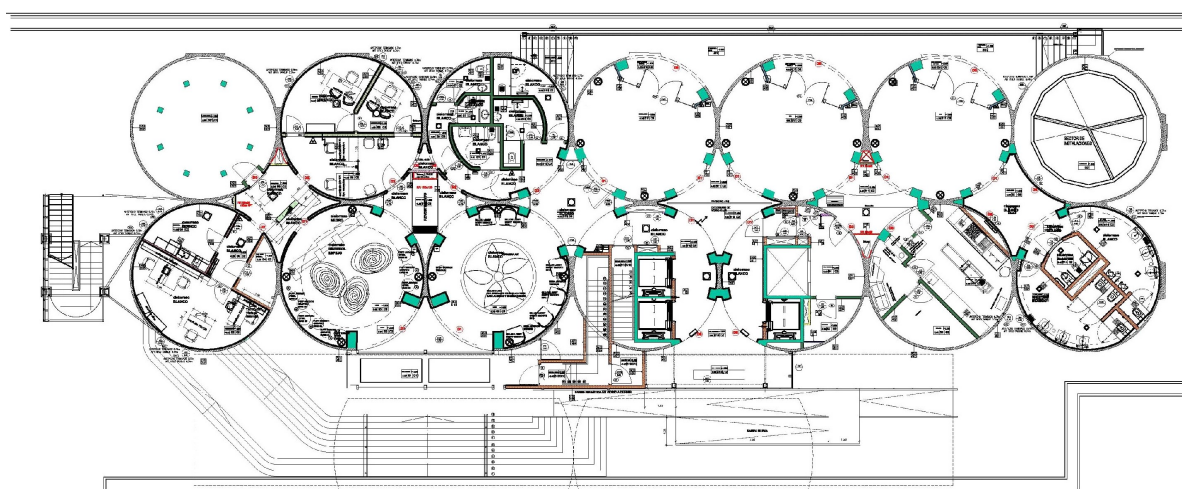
Planta baixa do pavimento térreo do Puerto Norte Design Hotel, Rosario.
